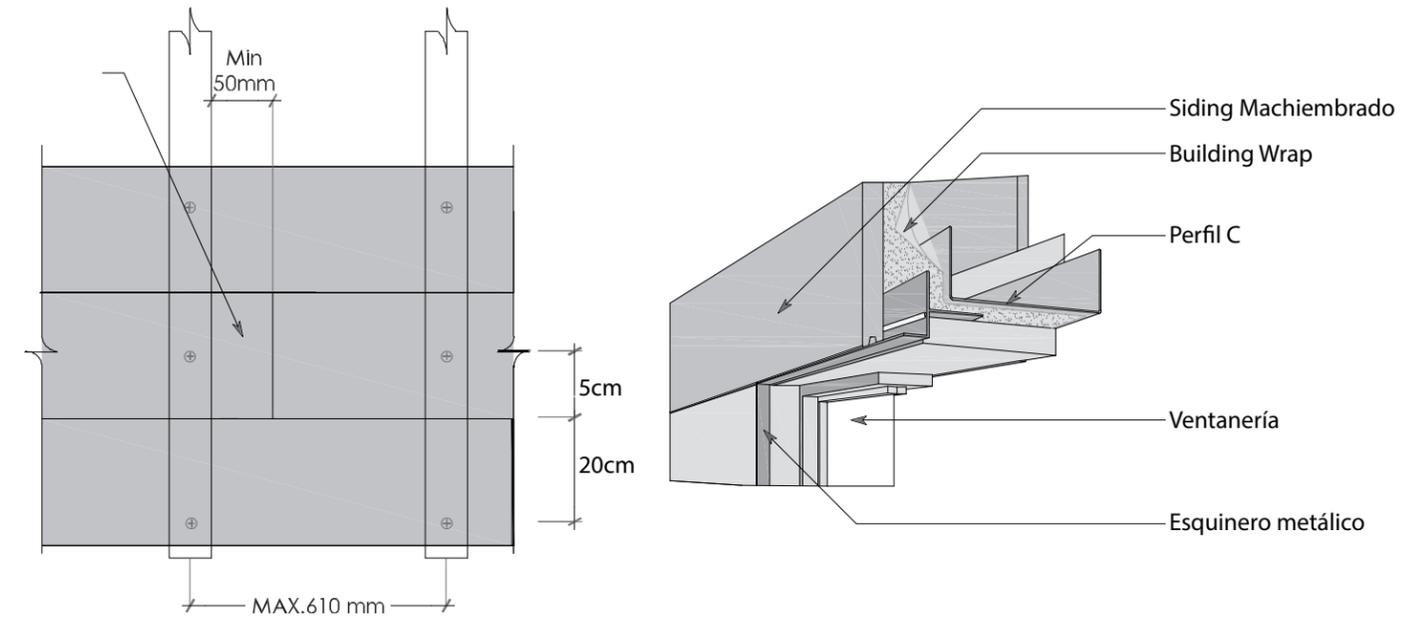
Detalle revestimiento. Fuente: Propia.
